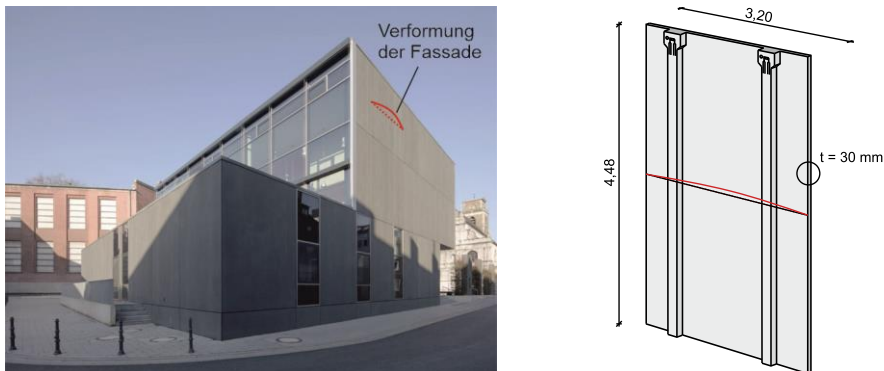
Textilbetonfassade Gymnasium St. Leonard in Aachen (Quelle: Robert Mehl); Skizze der Fassadenplatten mit vertikalen Verstärkungsrippen (Quelle: IMB RWTH)
